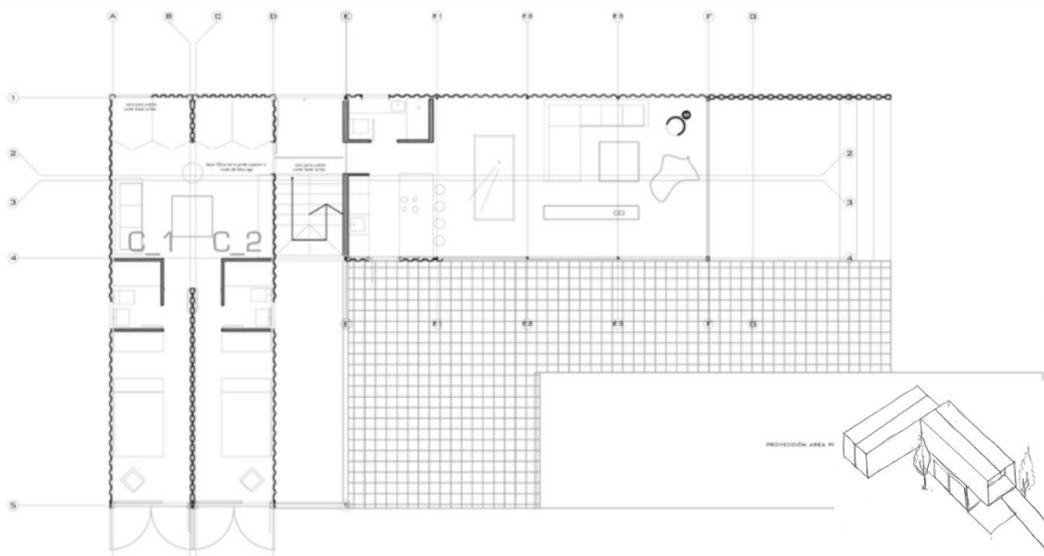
Casa el Tiemblo, Plantas arquitectónicas
